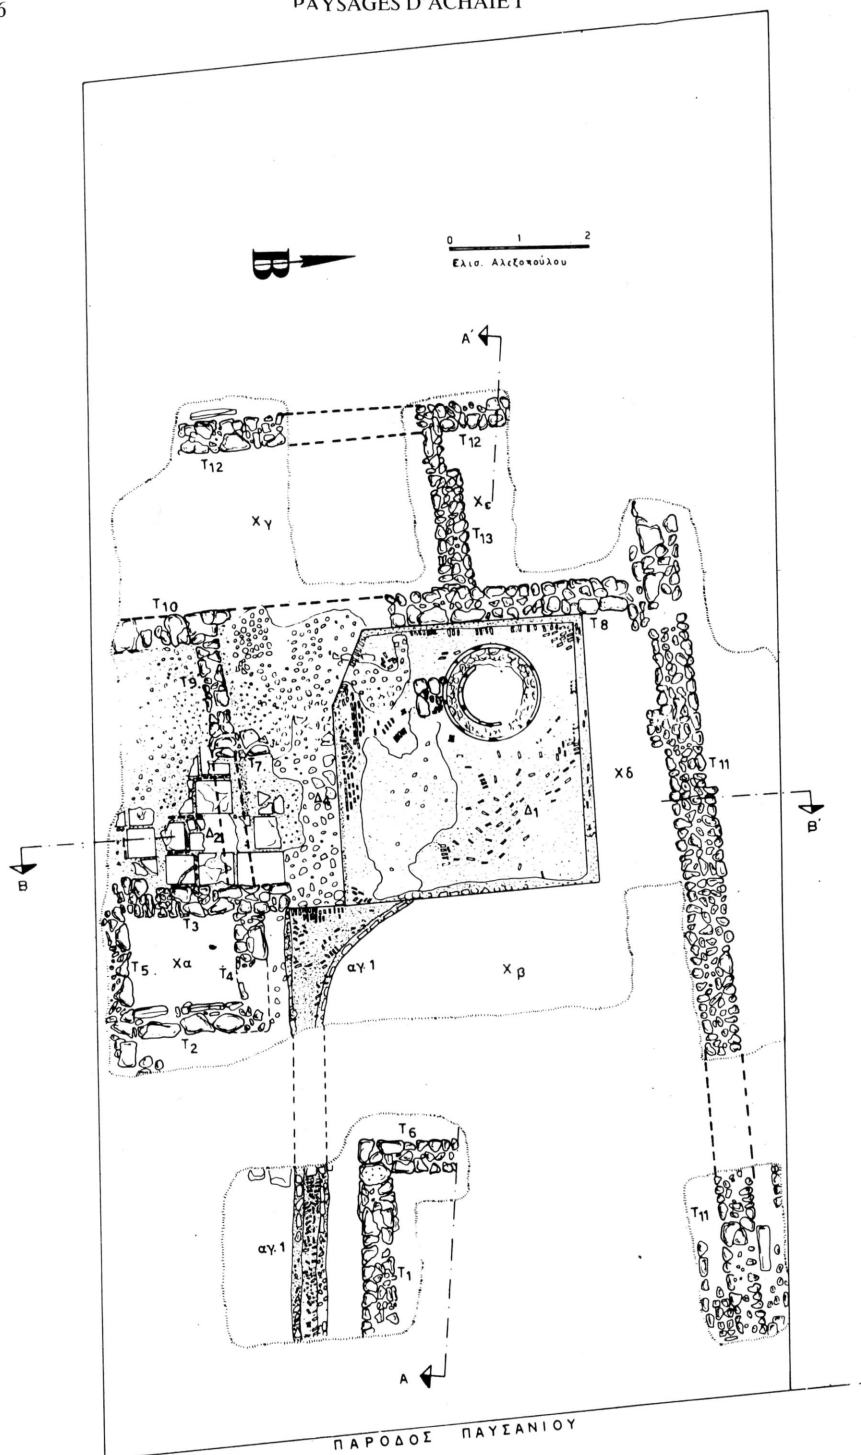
Plan d'une construction antique (Impasse Pausaniou).
